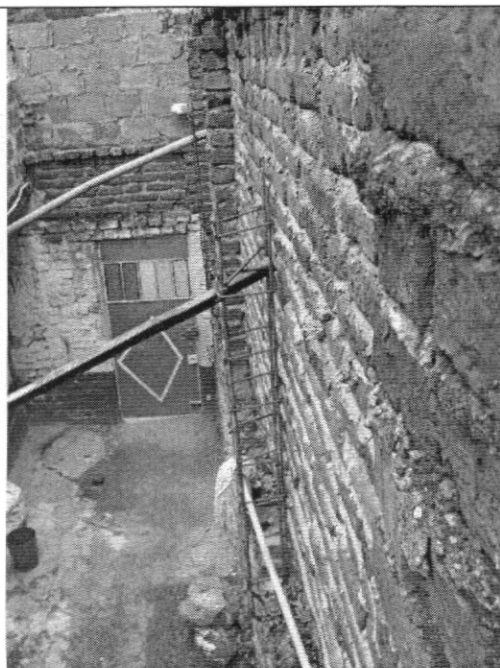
Trabajos de reforzamiento del muro, vista interna, se aprecia además la diferencia de altura con la externa
